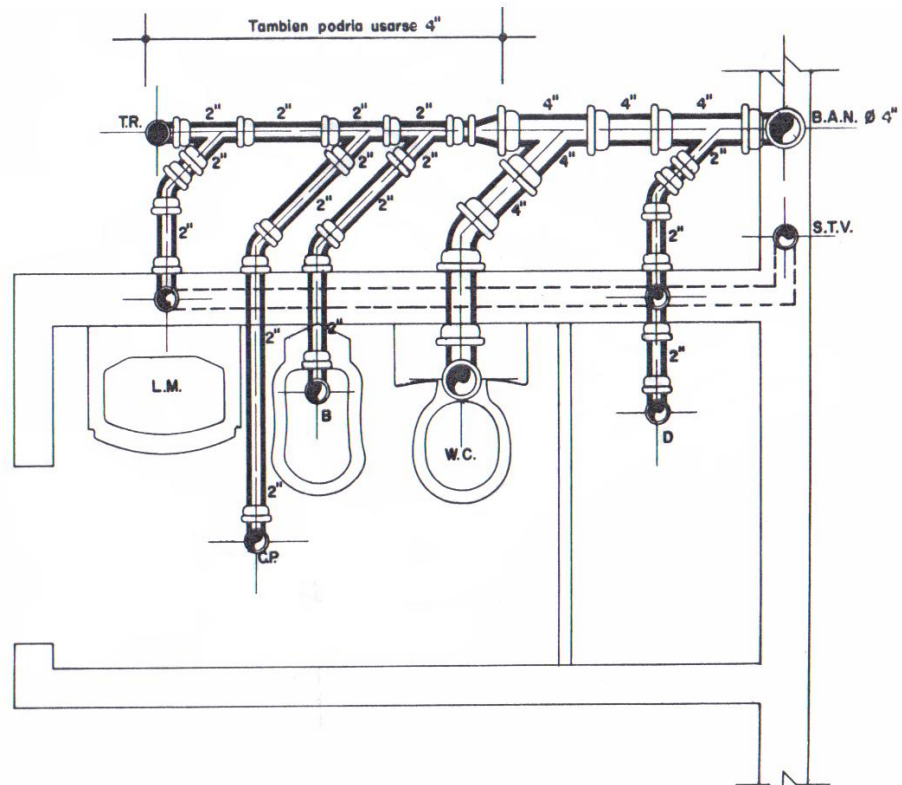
Ventilación Húmeda para edificaciones de uso publico - Planta
